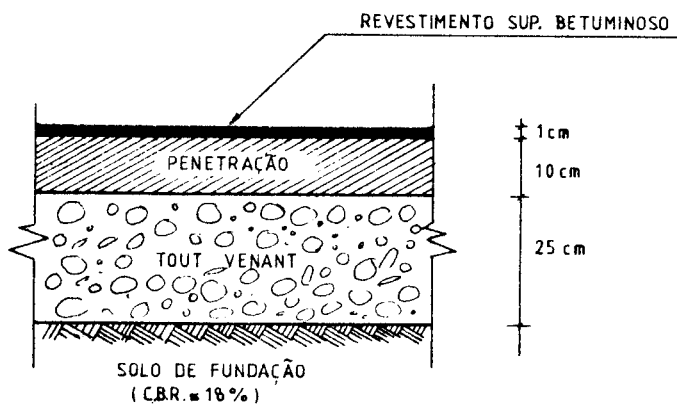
Perfil-tipo de um pavimento flexível equivalente ao rígido executado
